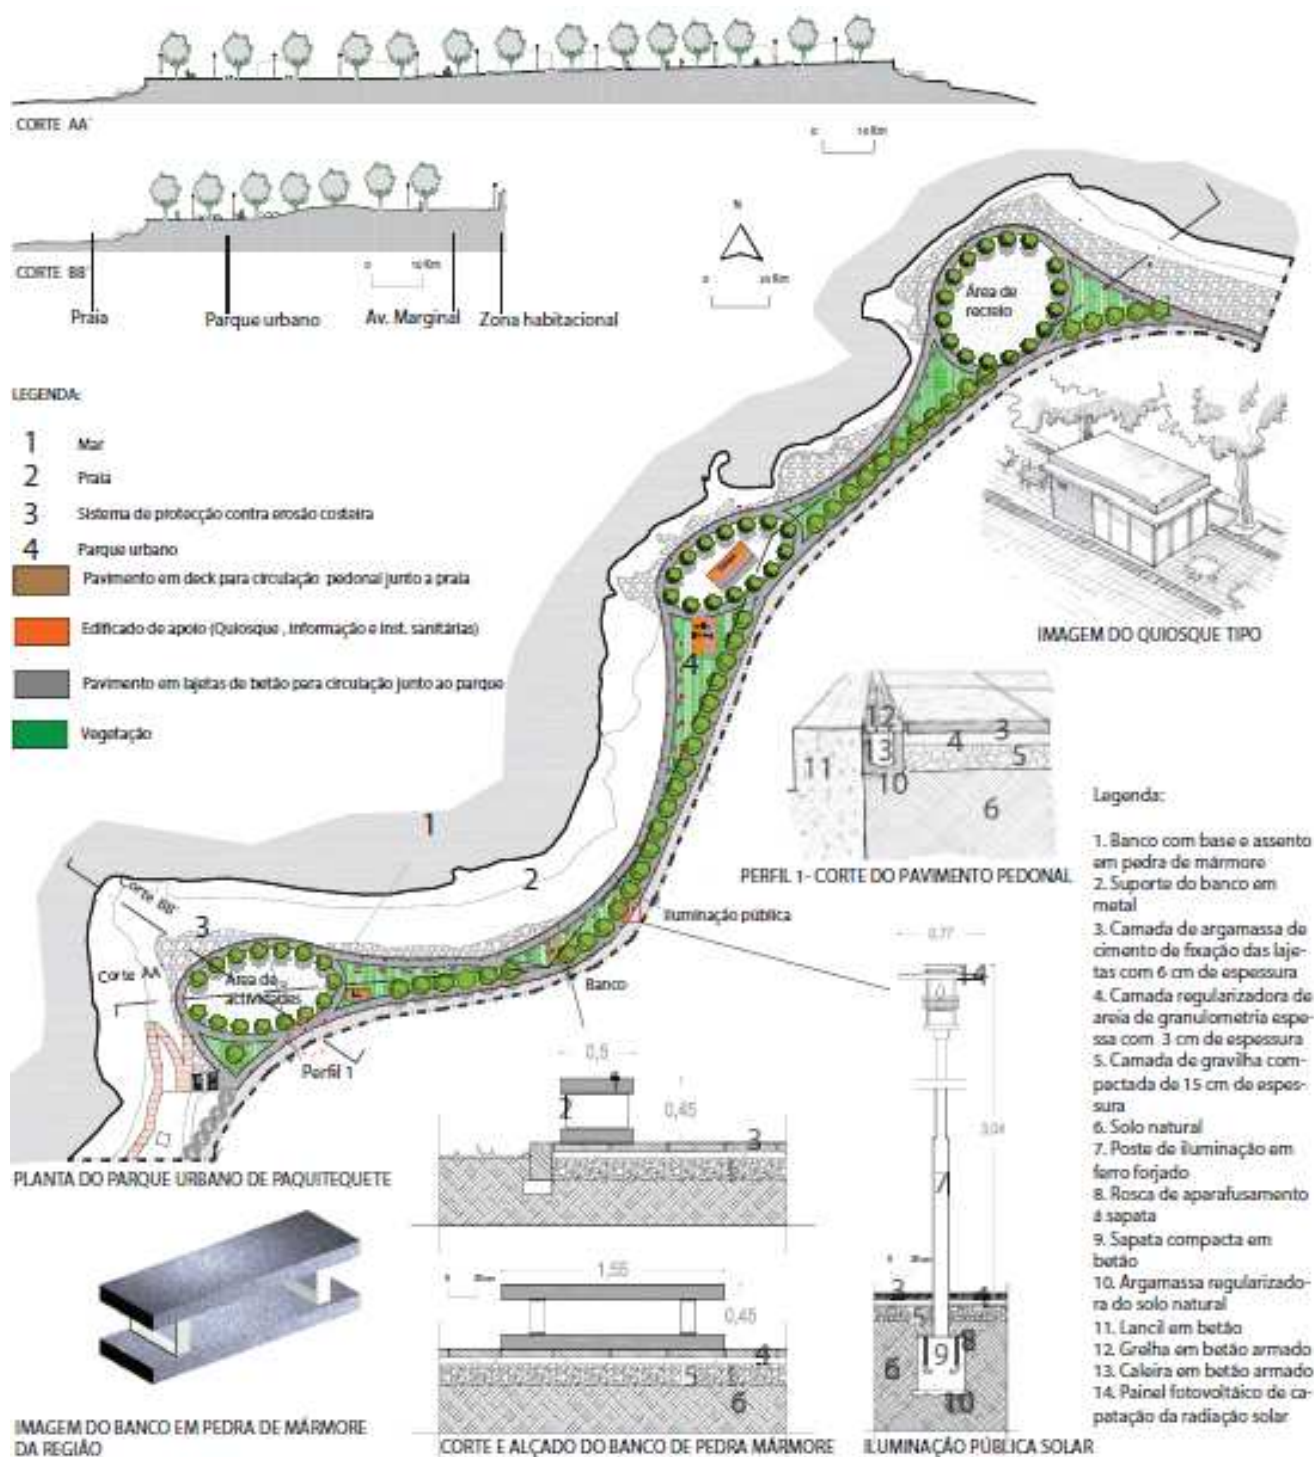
Planta do Pormenor do Parque urbano e do mobiliário urbano tipo (Fonte: autor)
